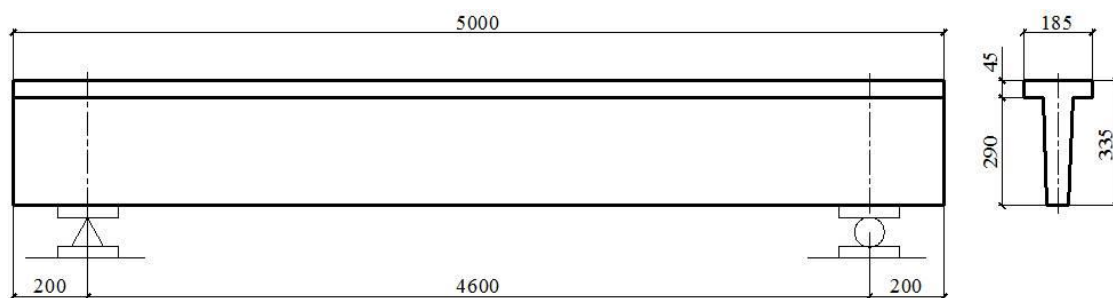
Конструкция стеклопластбетонной балки таврового сечения
